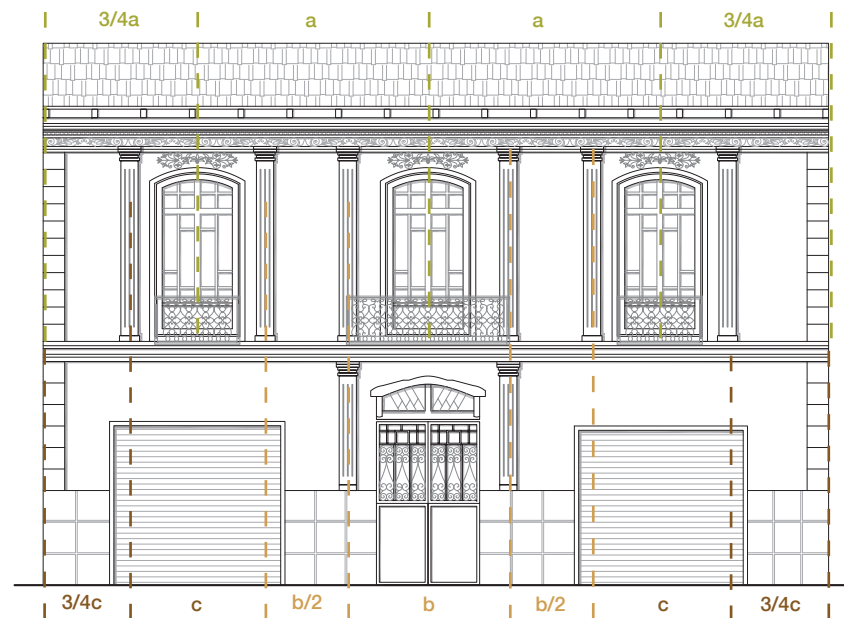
Fachada Este “Casa Armijos” con análisis de ritmo y repetición
